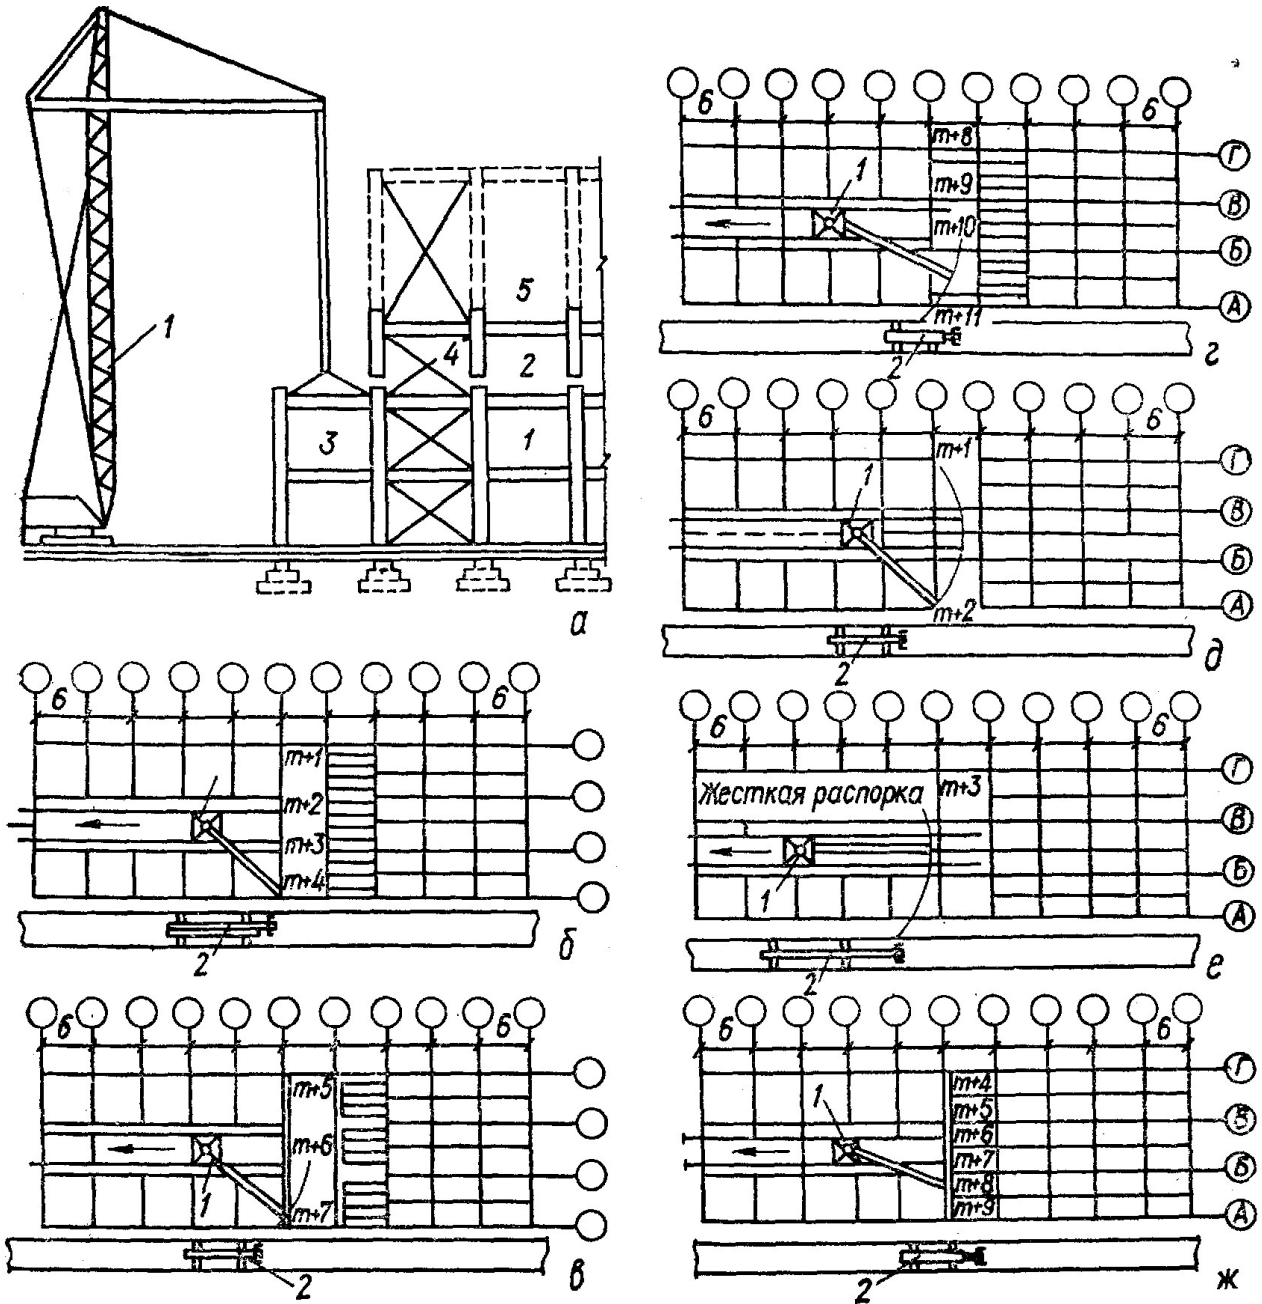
Схема монтажу каркасу з розташуванням крану в межах поперечного перерізу будівлі: а - схема розташування крану; б- монтаж колон; в - монтаж ригелів; г - монтаж плит; д - монтаж колон верхнього поверху; е - монтаж балок покриття; ж - монтаж плит покриття; m - кількість раніше змонтованих елементів.
